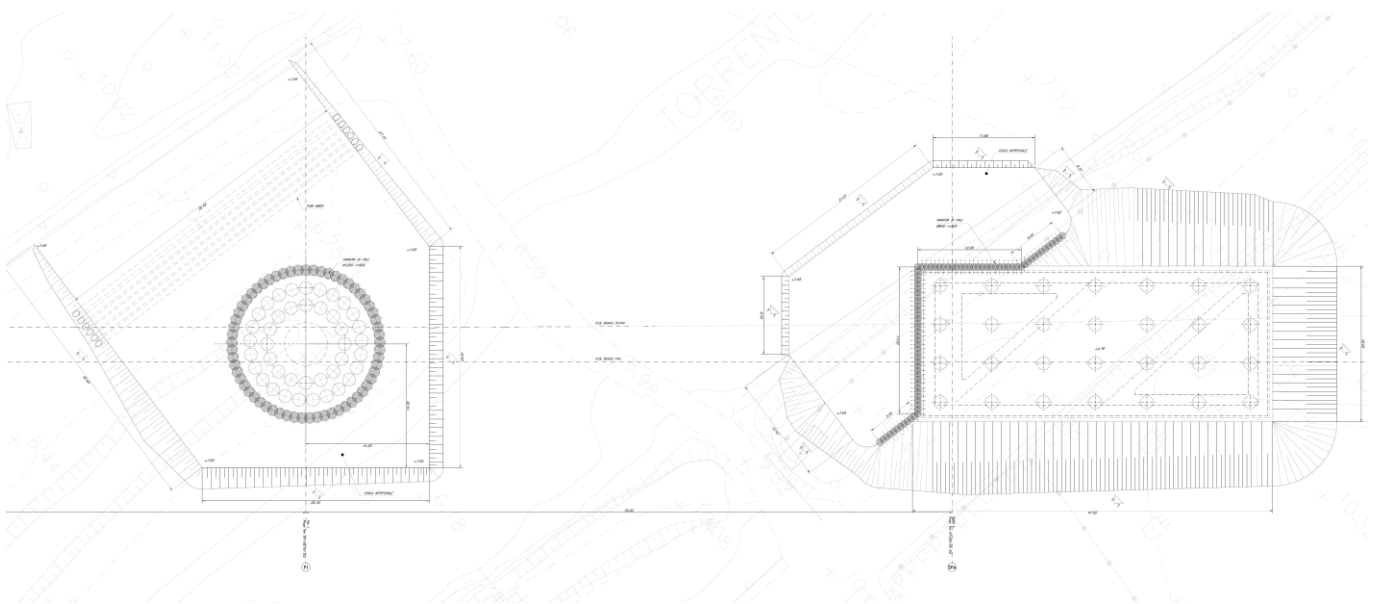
Vista in pianta delle opere provvisionale Spalla A e Pila
